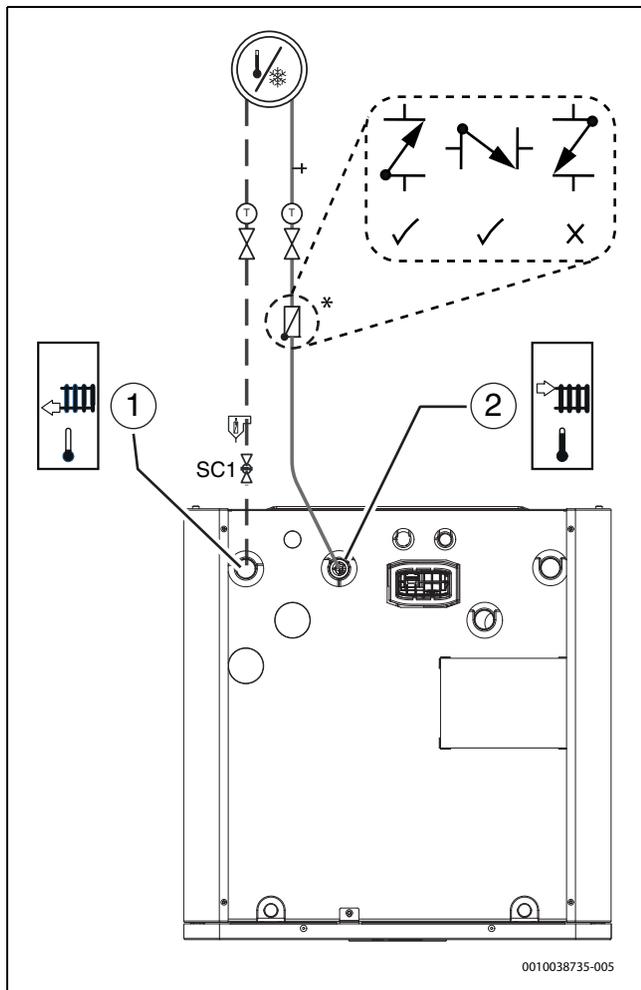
Collegamenti dell'unità interna all'impianto di riscaldamento
